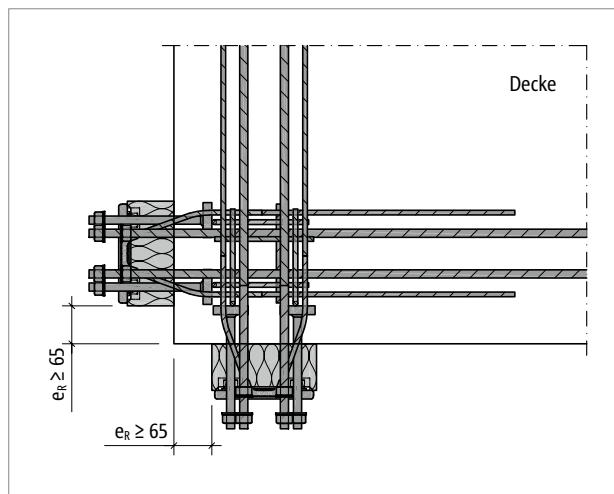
Schöck Isokorb® T Typ SKP: Randabstände an der Aussenecke bei senkrecht zueinander angeordneten Isokorb®
